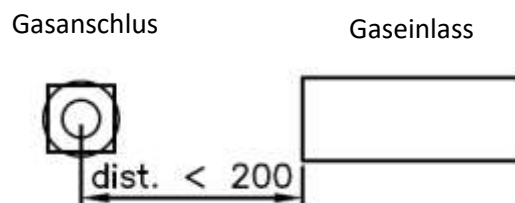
Mindestabstand beim Schweißen mit Gasen zur Anlage
